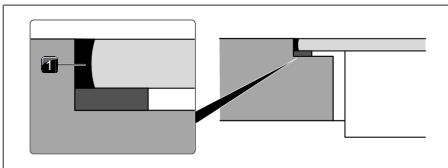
Silikoneforseglingsmasse ved planlimet montering
